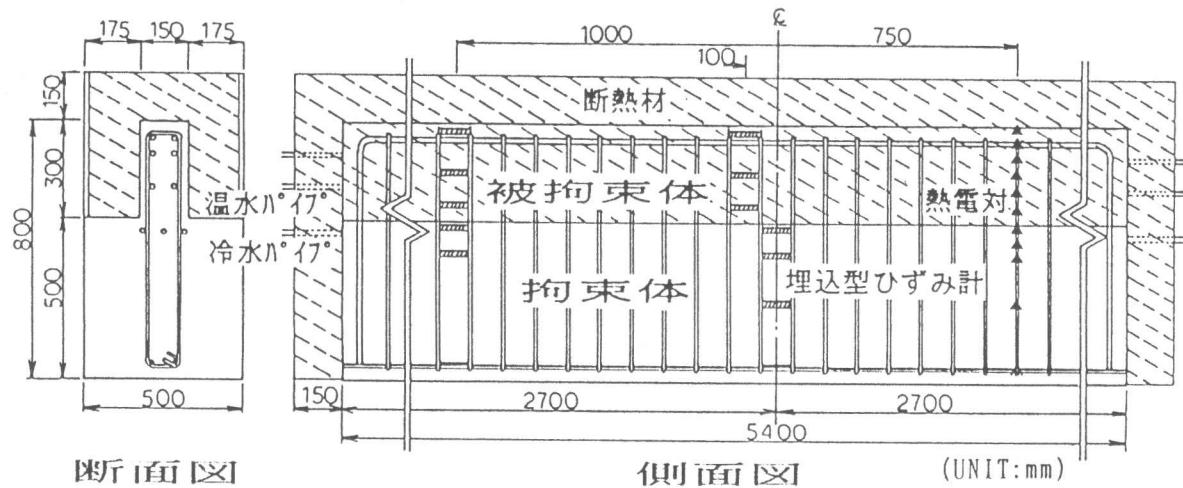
供試体の諸元、配筋および温度ひびわれ実験方法
